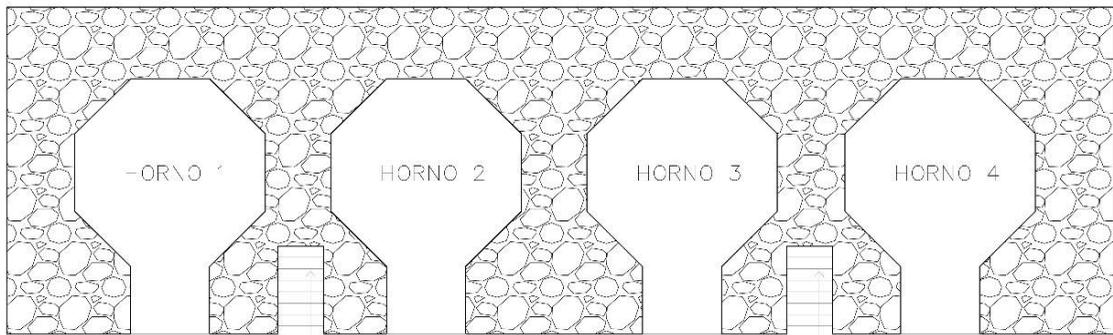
Planta arquitectónica de los hornos en la planta Santa Ana. Fuente: elaboración propia.
